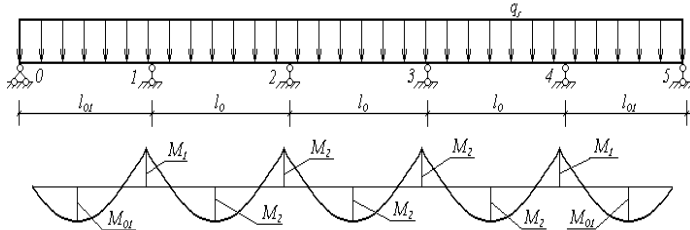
Розрахункова схема та епюра згинаючих моментів плити
